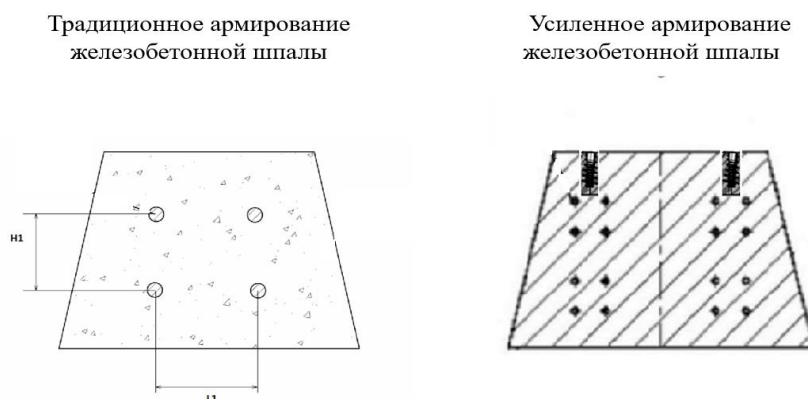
Дополнительное усиливающее армирование железобетонной шпалы
